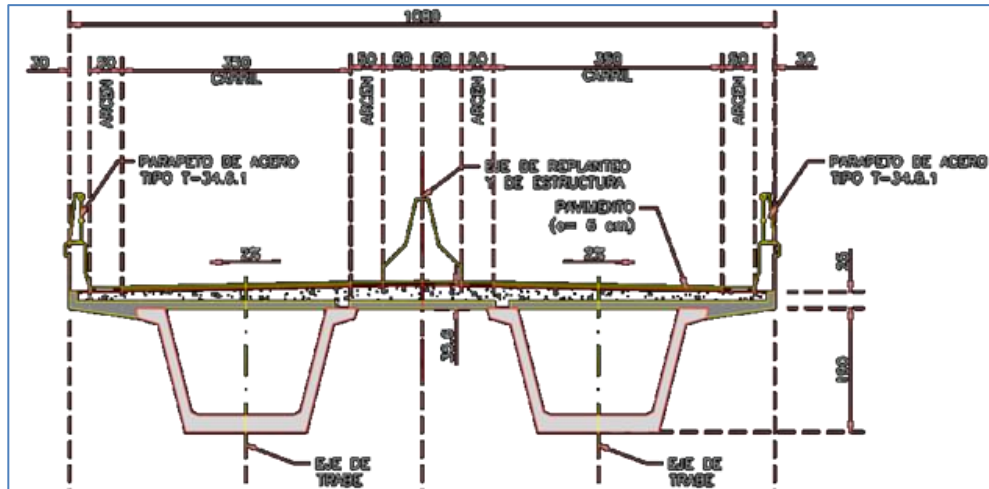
Sección de 10,8 m de ancho con 2 vigas de 1,9m de canto.
